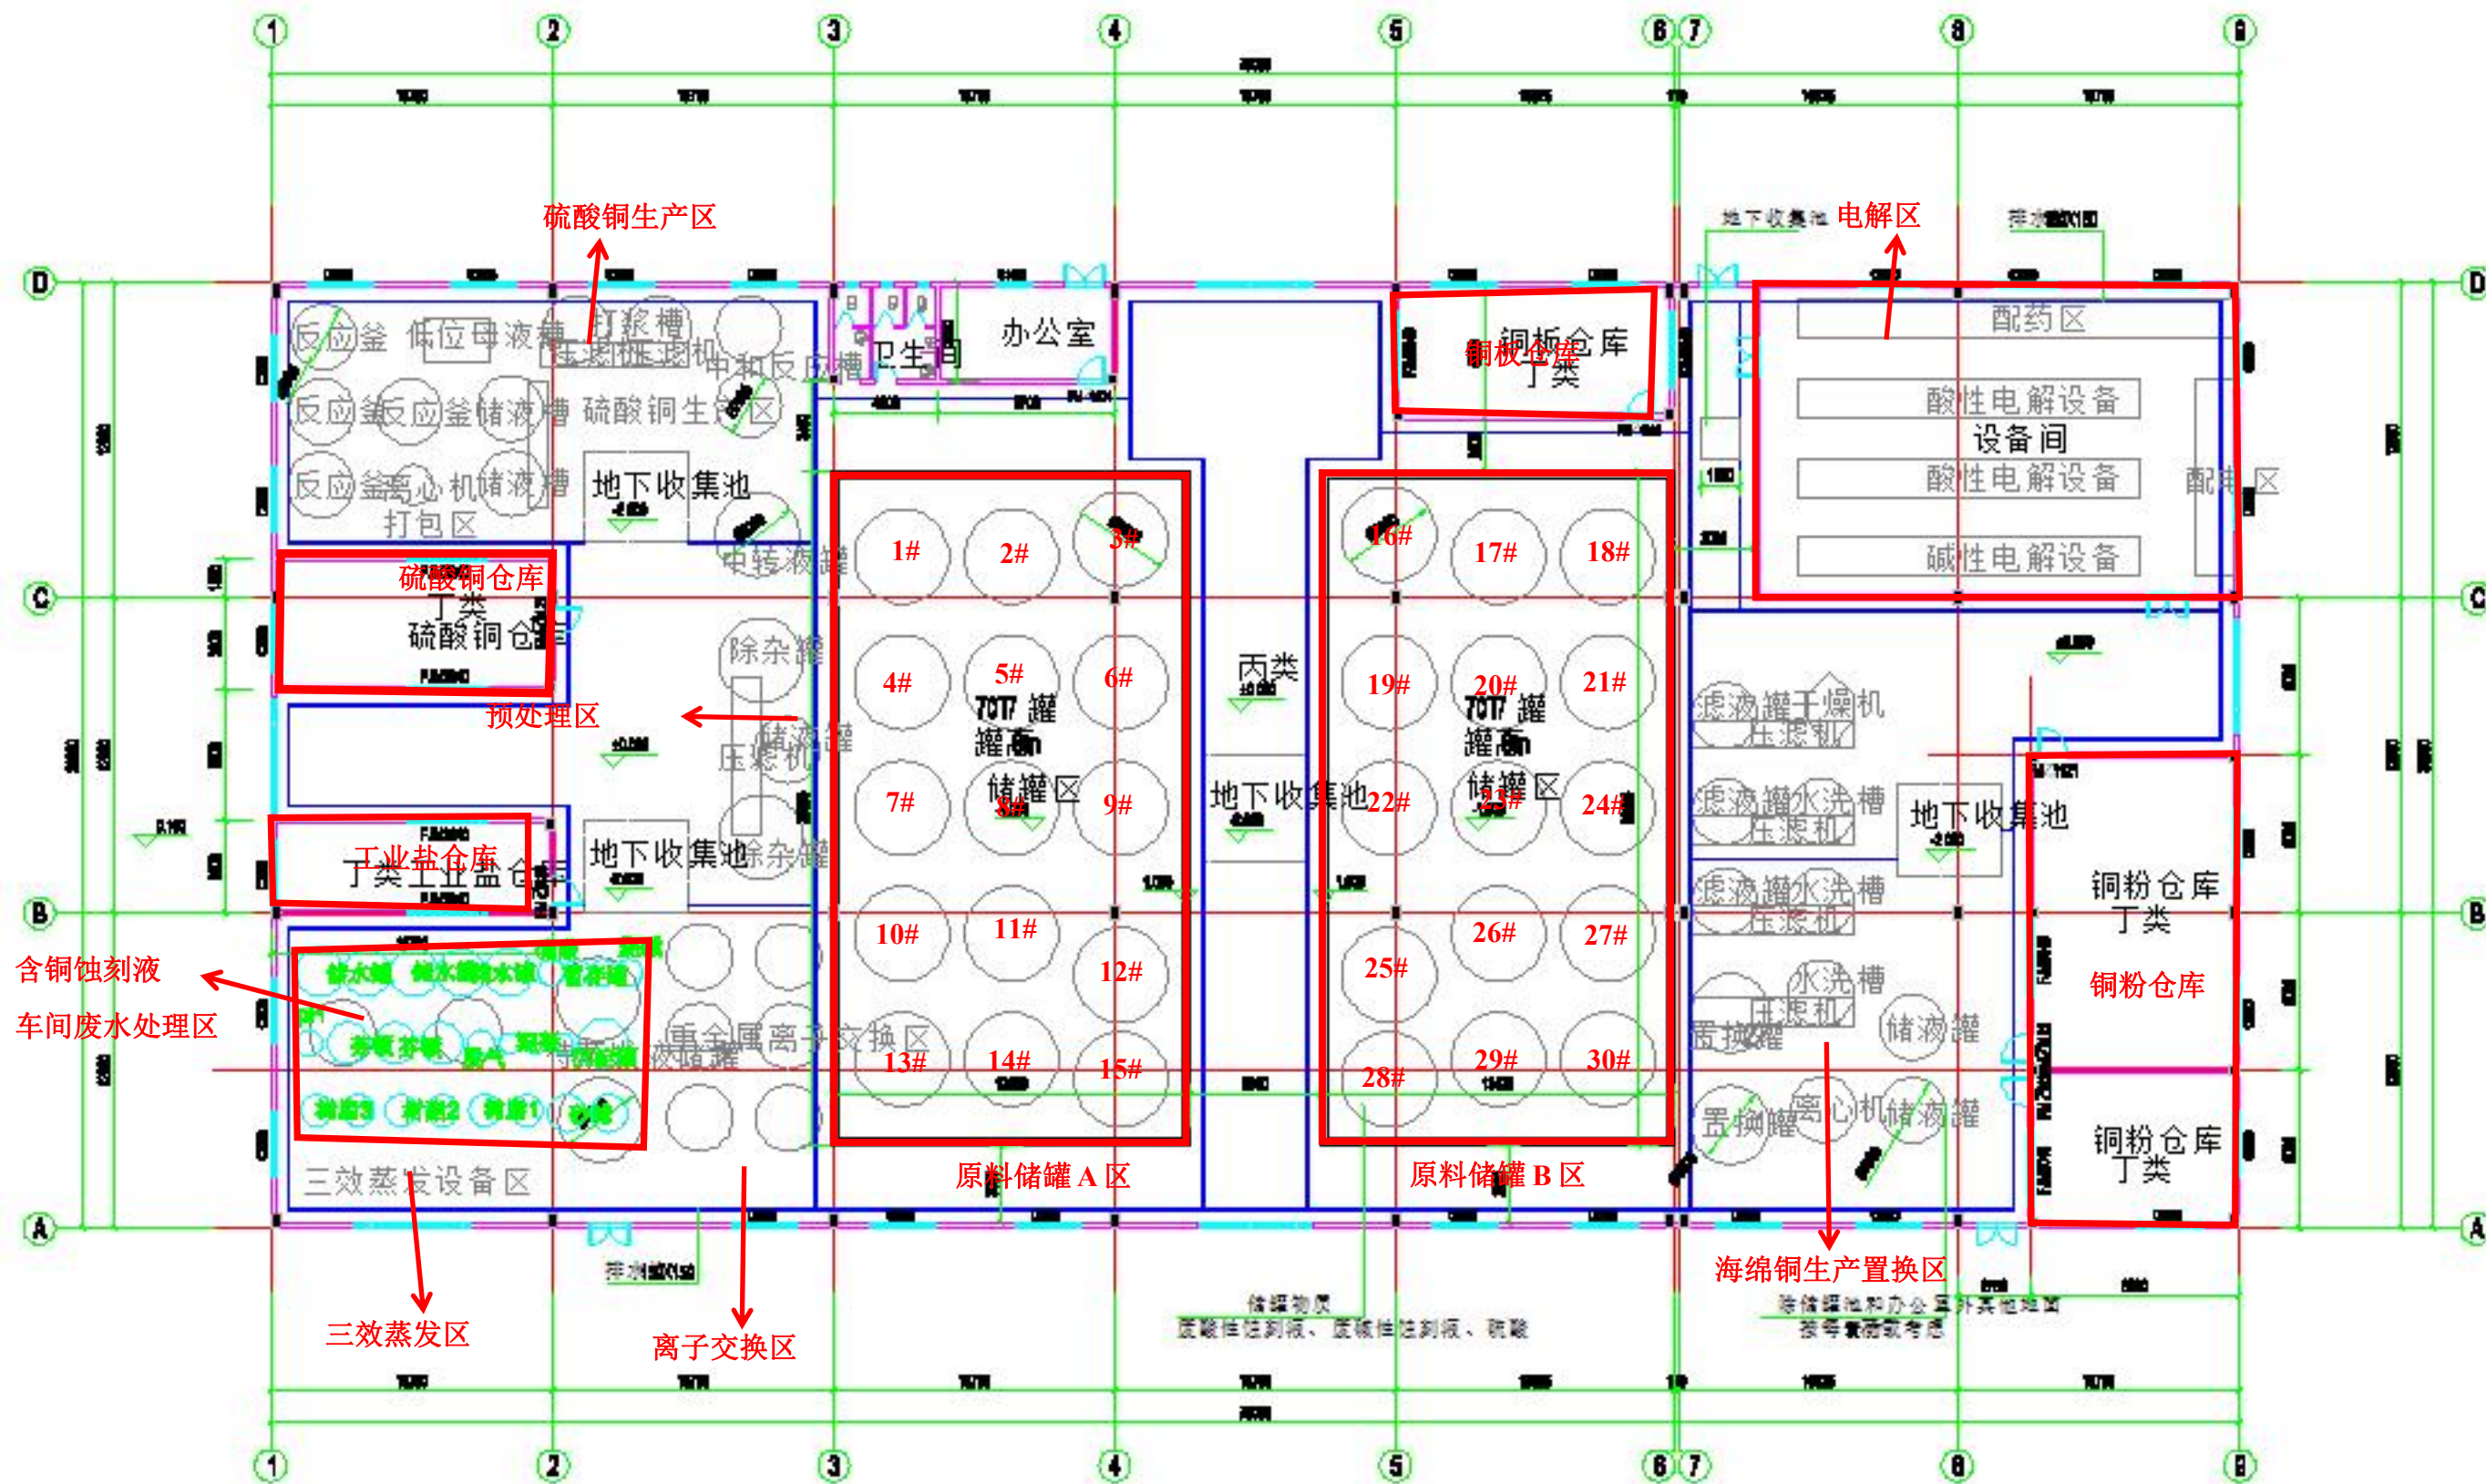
含铜蚀刻液（车间二）生产车间平面布置图
